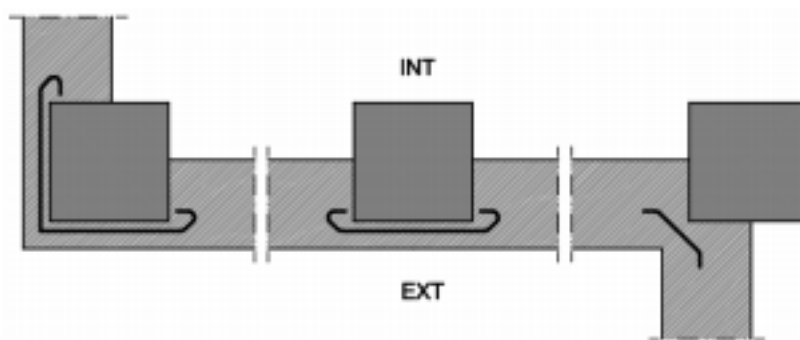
Ejemplo de encuentro de la fachada con los pilares
